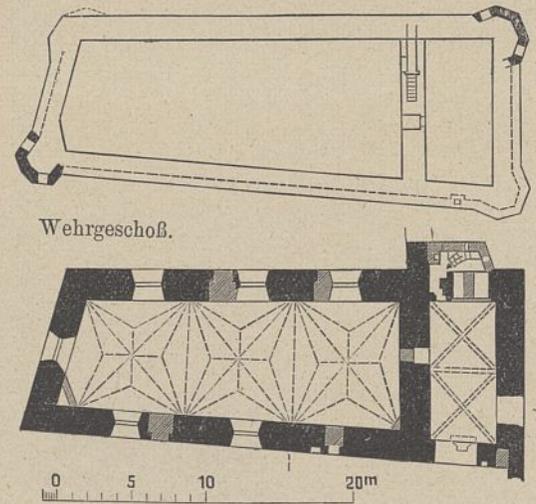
Die Ordensburg in Doblen. Palastgrundriß Hauptgeschoß. 1:500.
